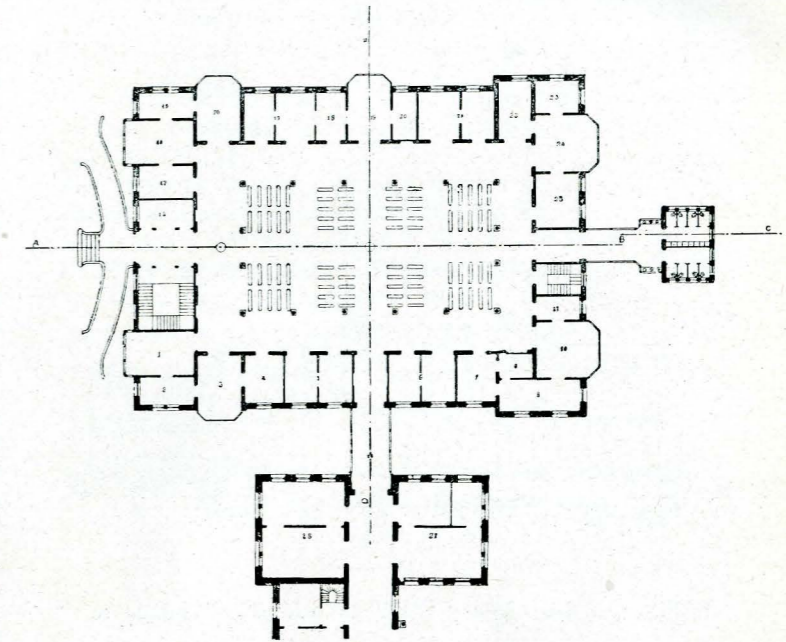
Pianta del piano terreno dell'Edificio di poliambulanza.
